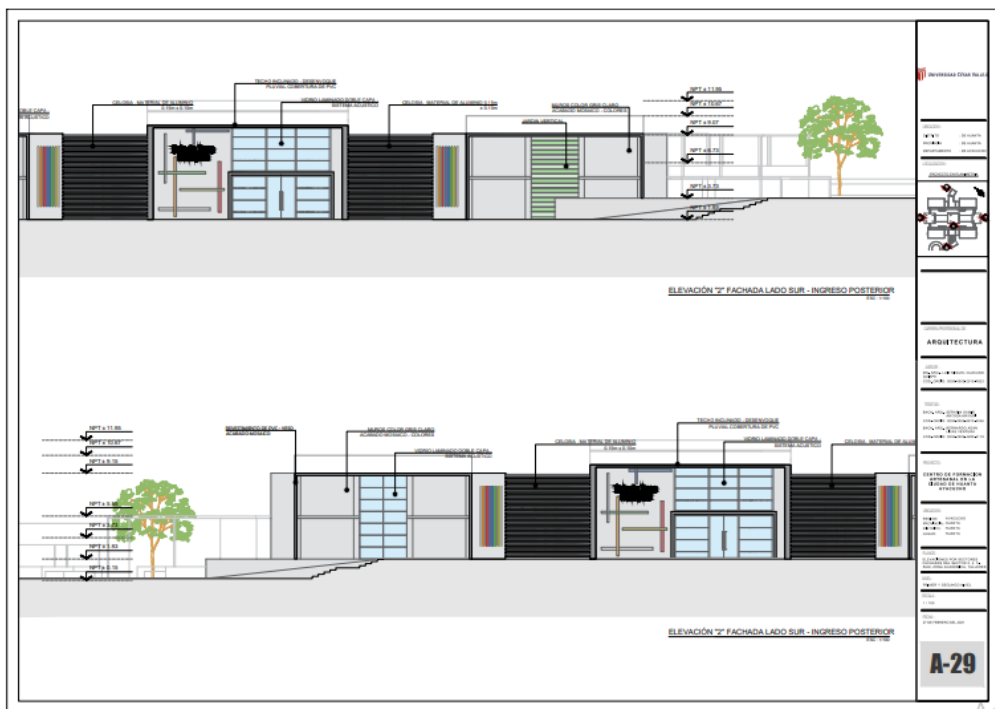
Elevaciones del lado sur – fachada posterior escala 1/100.
